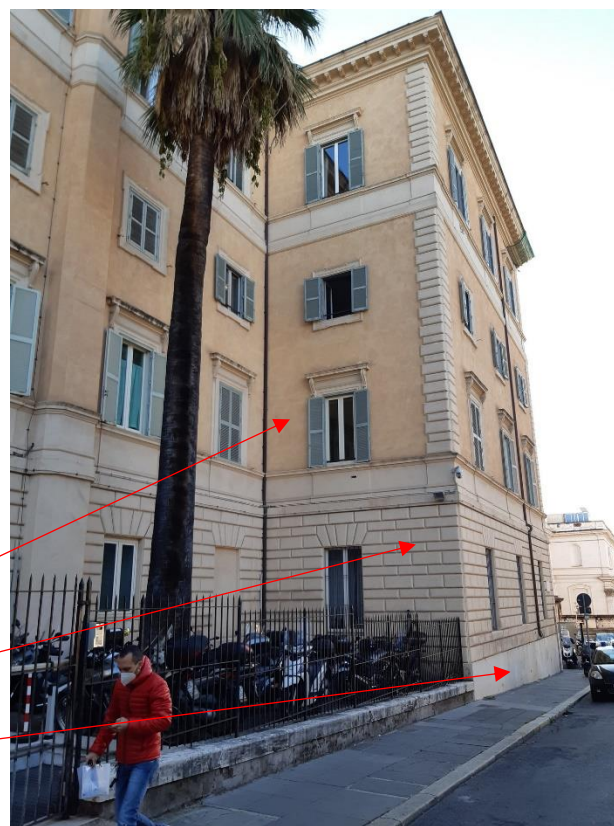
\_Prospetto via Ferrara angolo via Piacenza
